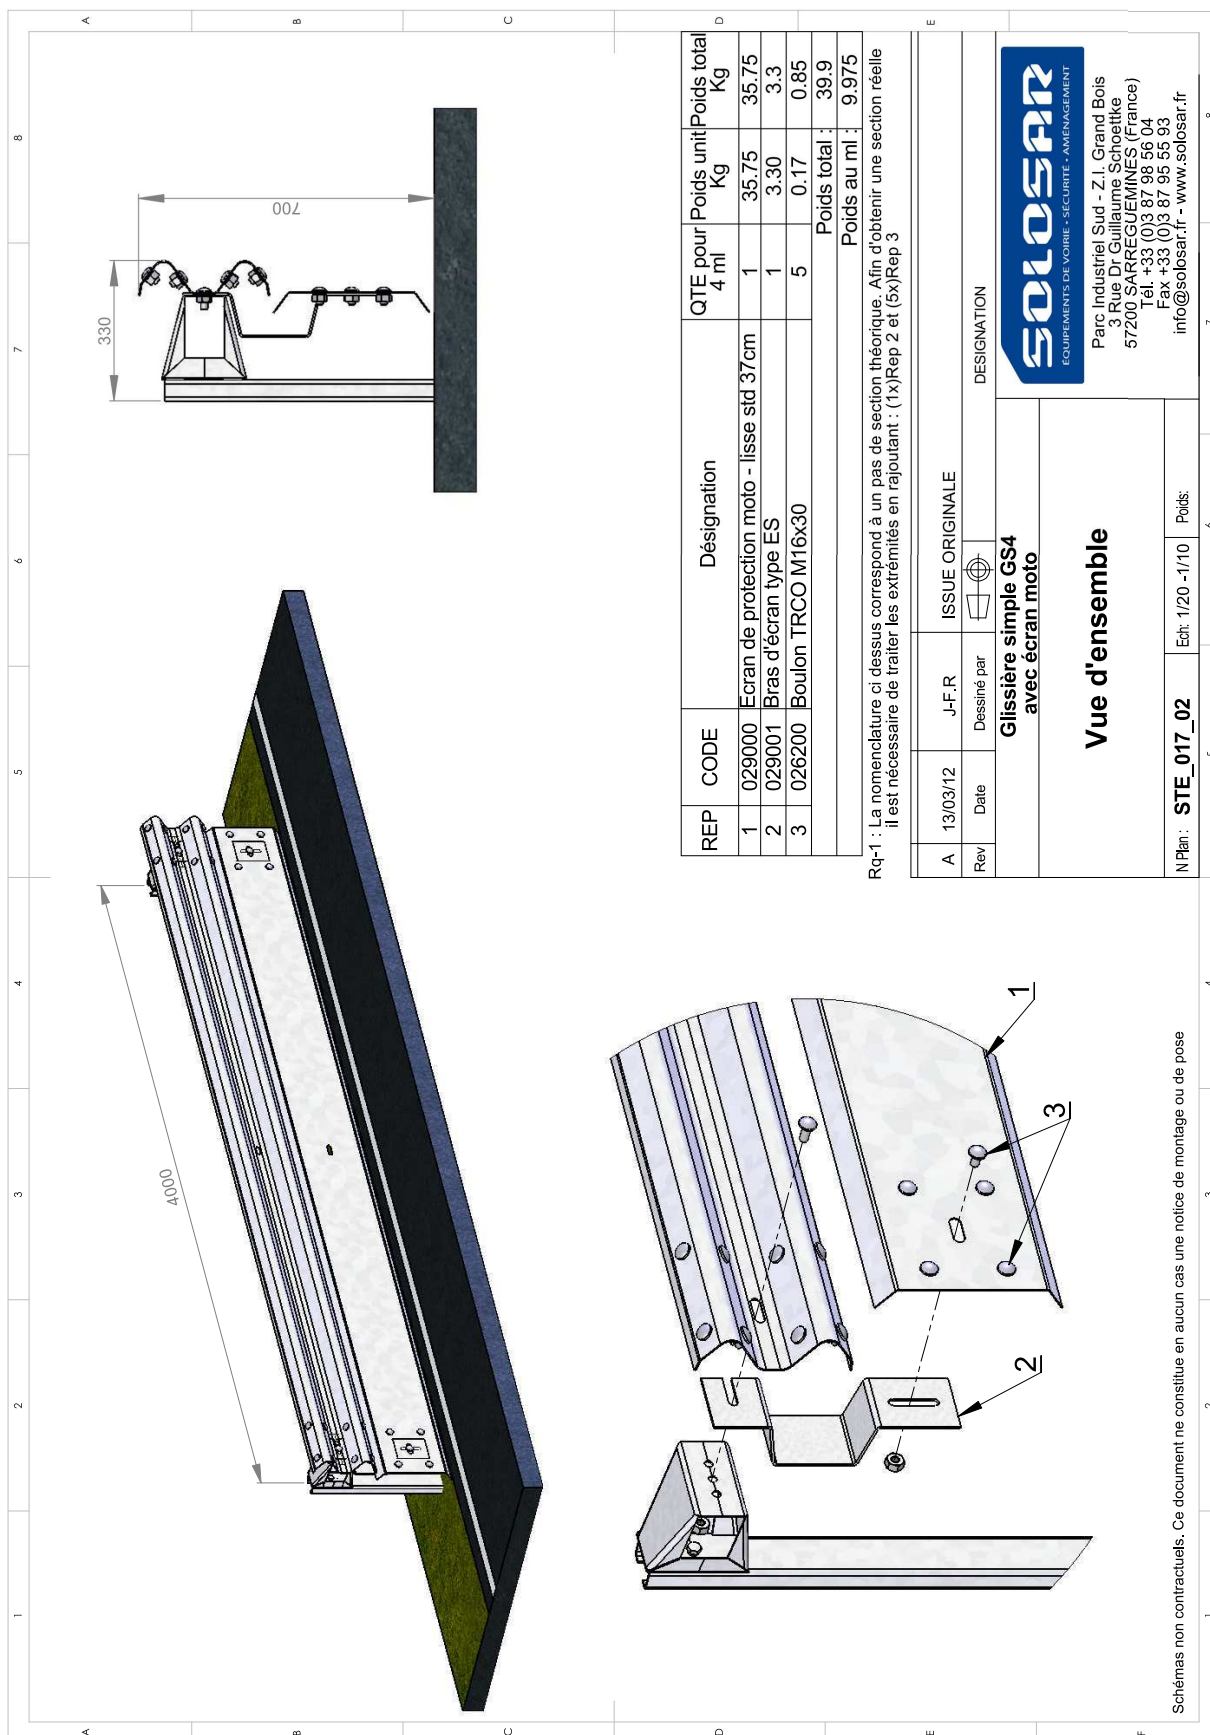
Plans du dispositif de retenue routier modélisé [62]
